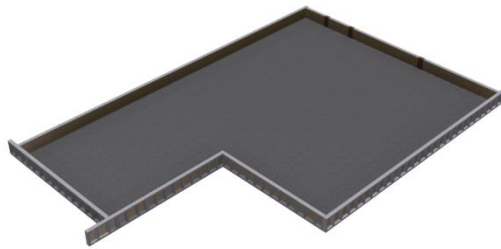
Montagem dos painéis metálicos para a cofragem da laje
